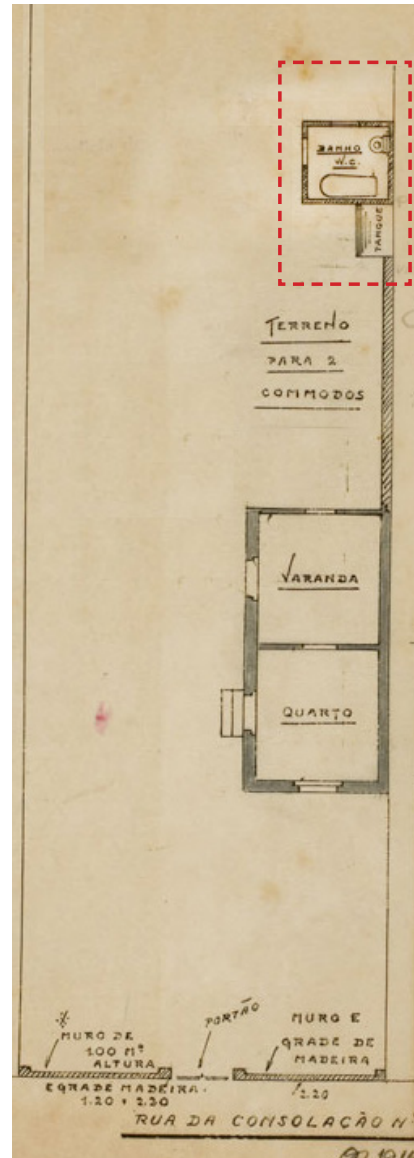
e 3.17 Plantas com cômodo sanitário tipo “A”.
